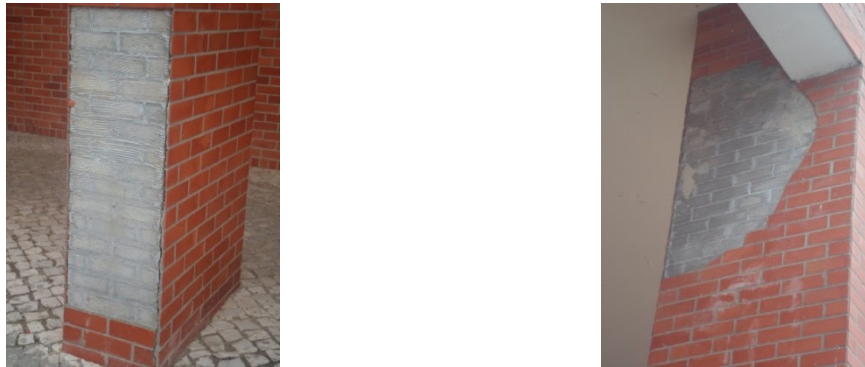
Destacamento do tijolo face-à-vista em pilares
